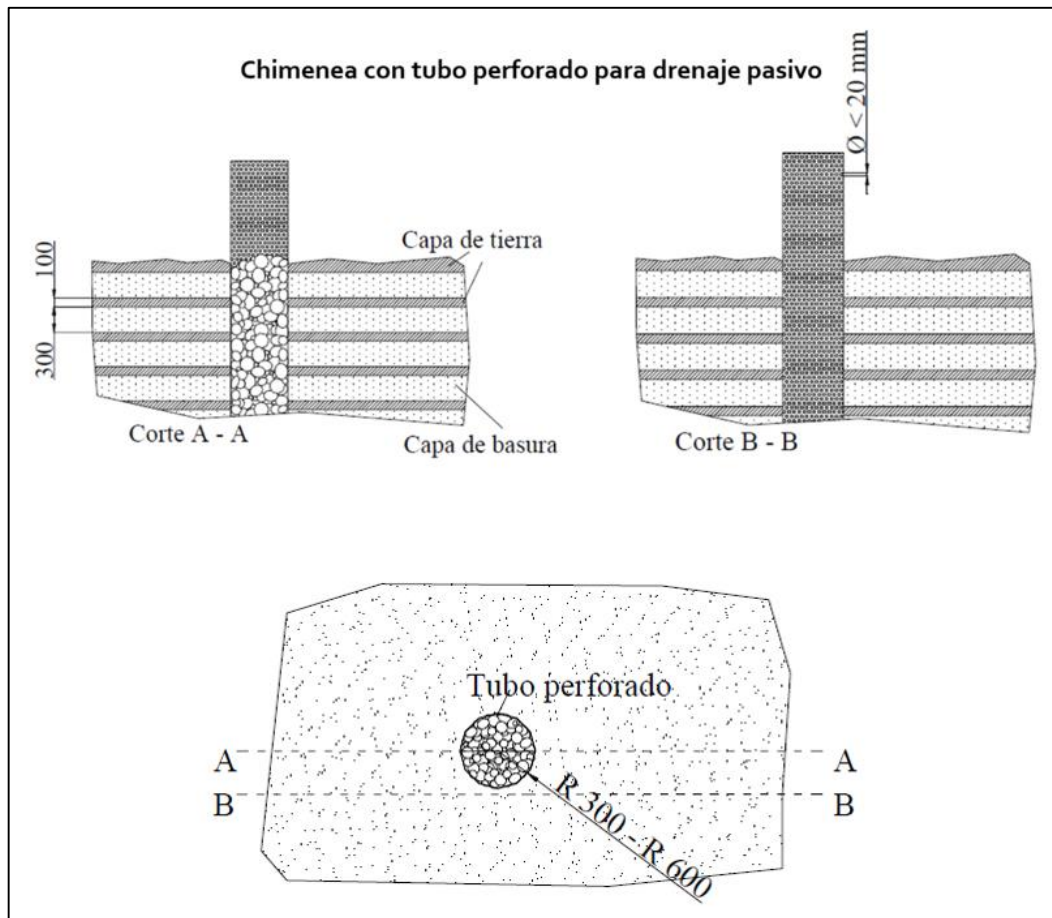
CHIMENEAS CON TUBO PERFORADO PARA DRENAJE PASIVO
